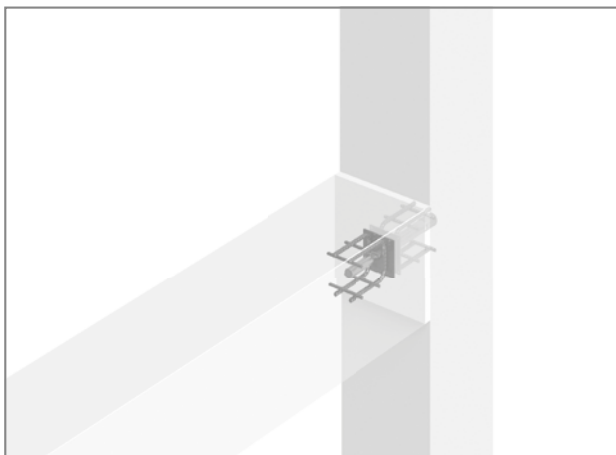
Schöck Dorn: raccordo trave in legno-pilastro
